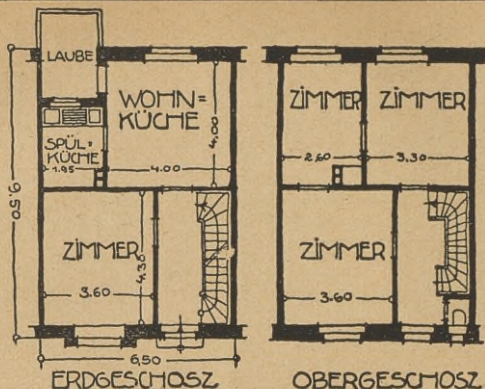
u. 76. Haus von 6,50 m Front aus der Siedlung Alfredshof in Essen. Beb. Fläche 61,75 qm. Architekt Schmohl
